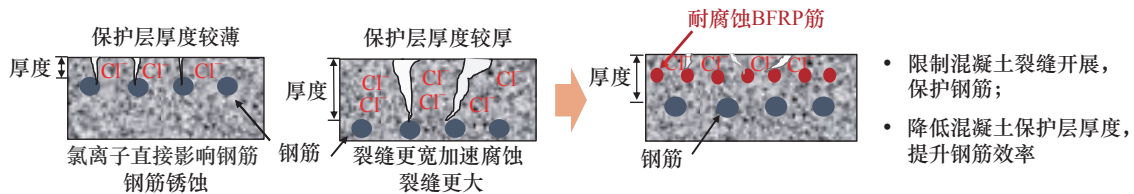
FRP 筋 - 钢筋混合配置混凝土结构示意图
